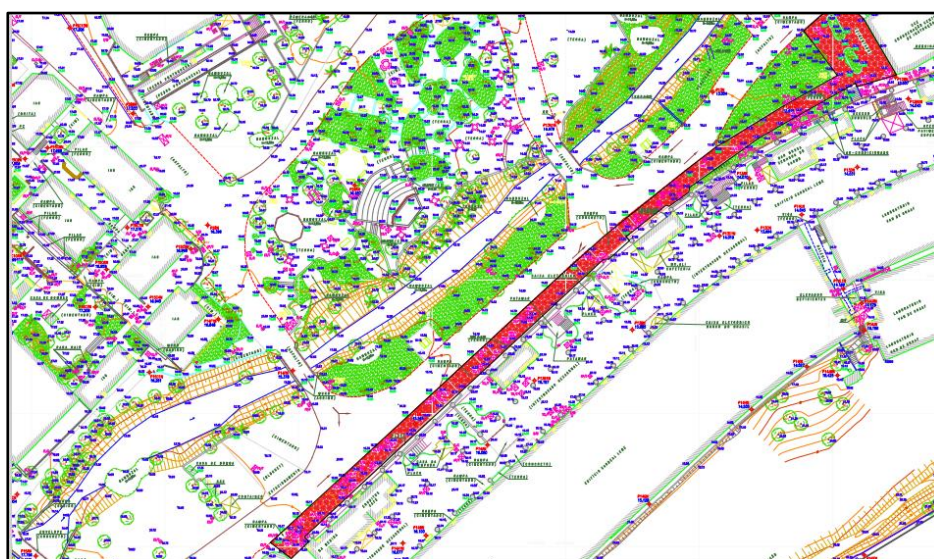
Extensão total em vermelho da aplicação do concreto permeável
